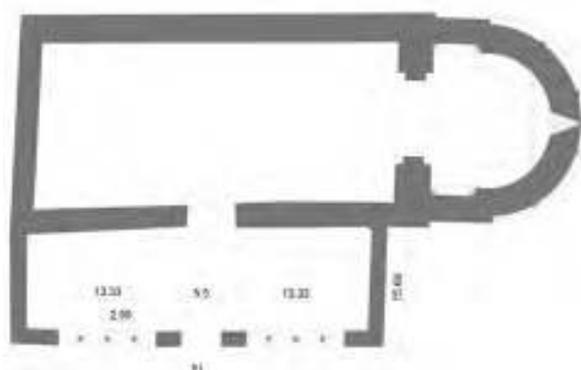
Planta hipotética del templo románico con la galería porticada (con medidas expresadas en pies).
